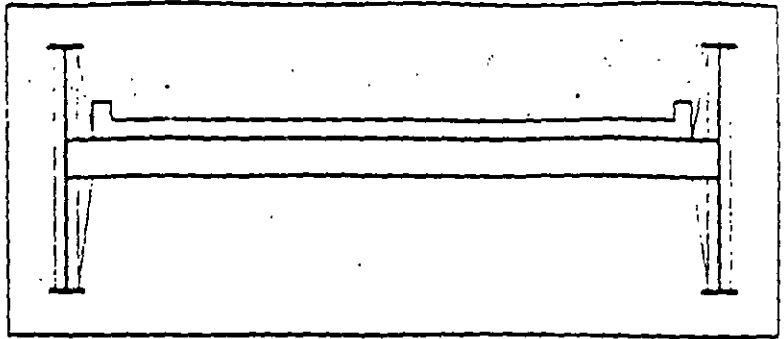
Sección transversal, tipo 43, Trabe de Alma Llena
